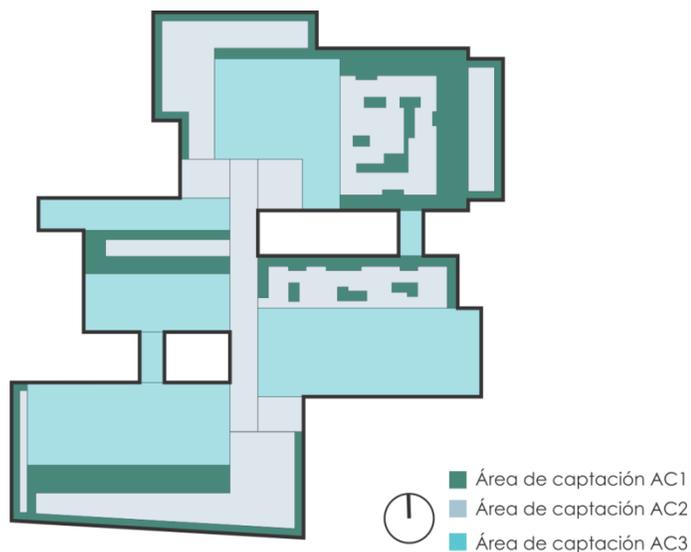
Clasificación de las áreas de captación por material, vista en planta.
